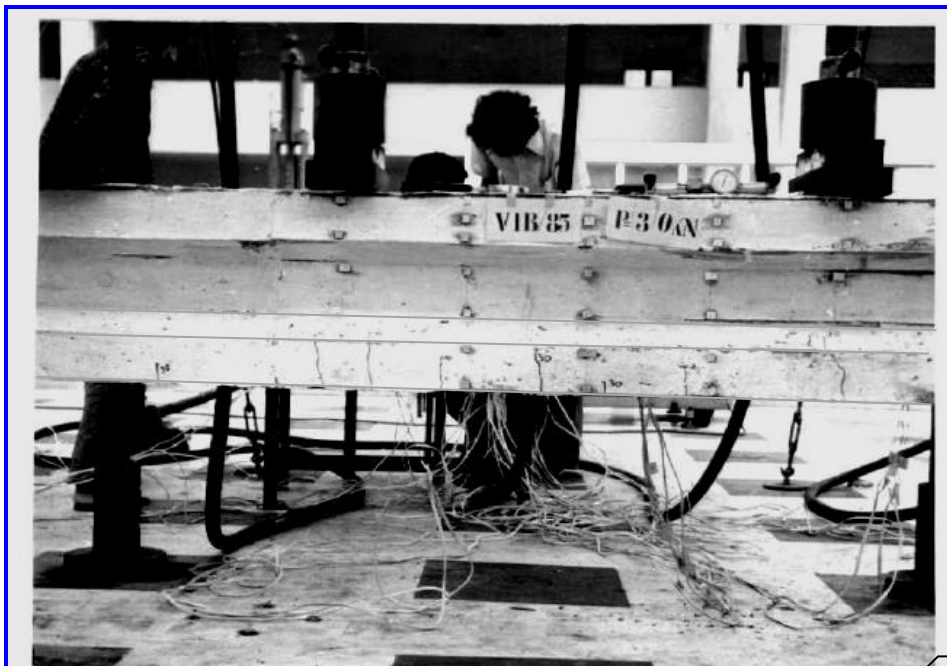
Primeiras fissuras da viga VIB/85
